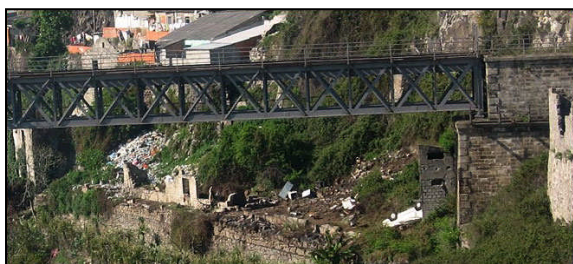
, Pormenor da estrutura da Ponte Maria Pia. Degradação urbana da envolvente.
